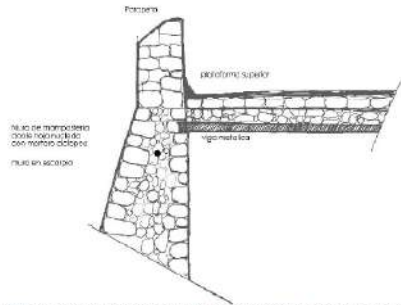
Detalle de muro perimetral fortificación militar Sisal Yucatán. Elaboración Karla Gómez 2018.
